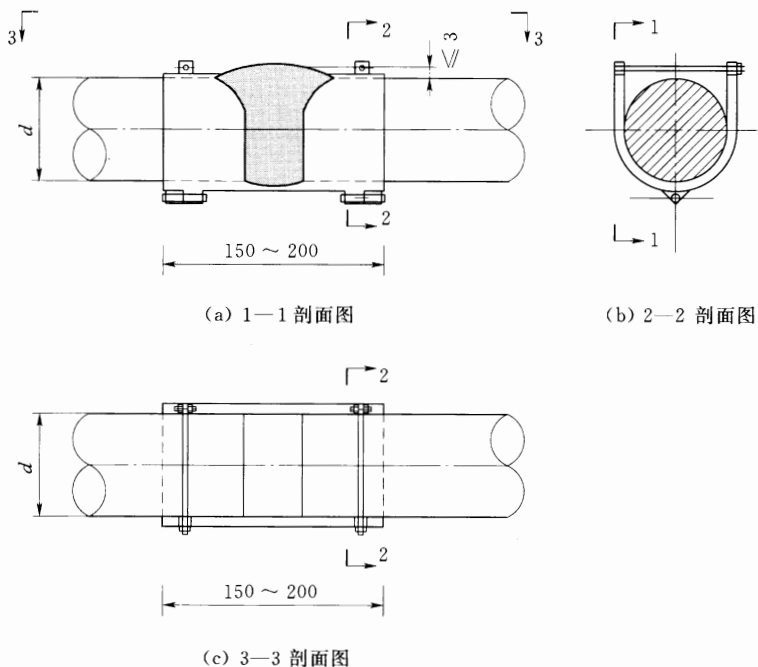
窄间隙焊 (单位: mm)
